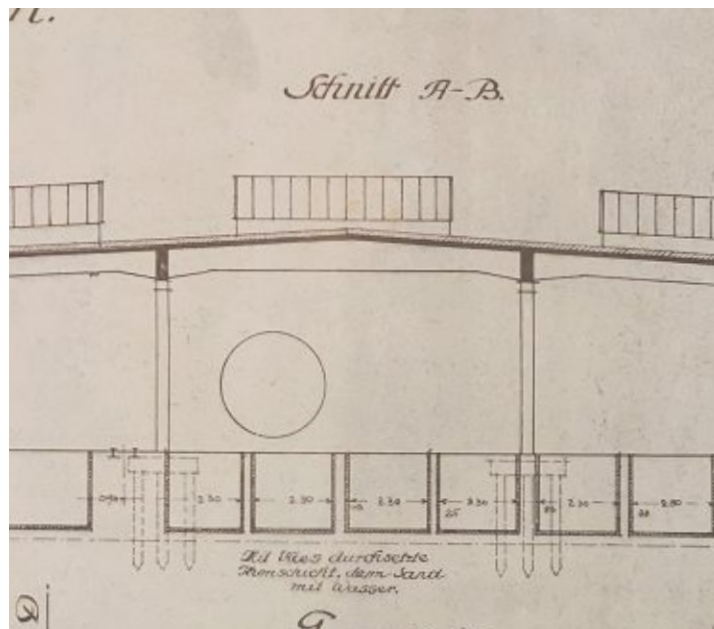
Schnitt durch ein Grubenhaus in Eisenbeton mit Pfahlgründung. Der Untergrund wird wie folgt beschrieben: „Mit Kies durchsetzte Thonschicht, dann Sand mit Wasser.“
